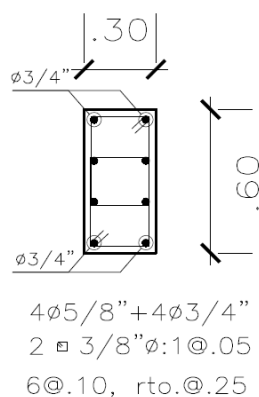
Detalle de armado de la columna entre los ejes A-2 de sistema de muros
